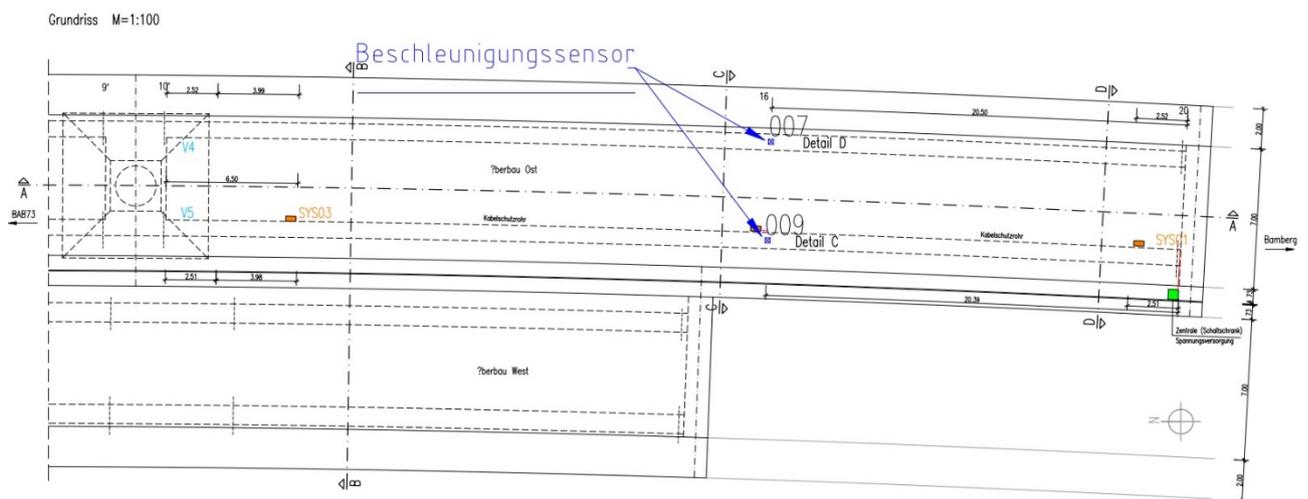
Lage der Beschleunigungssensoren in der Draufsicht, Quelle: Büro für Strukturmechanik GmbH
